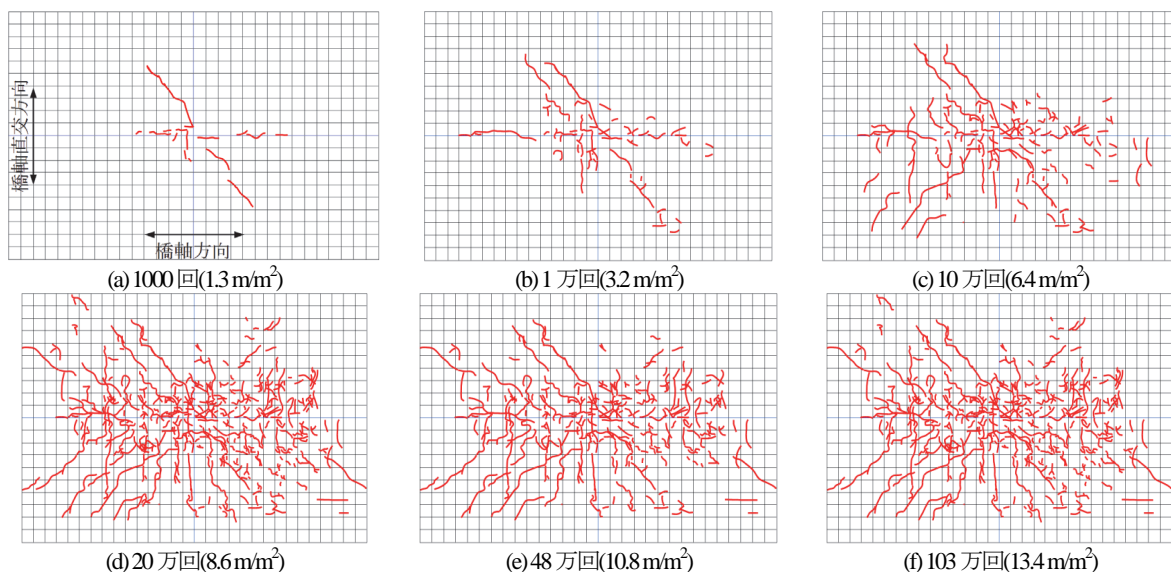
A 供試体のひび割れ状況 ()内数値 ひび割れ密度 m/m^2
